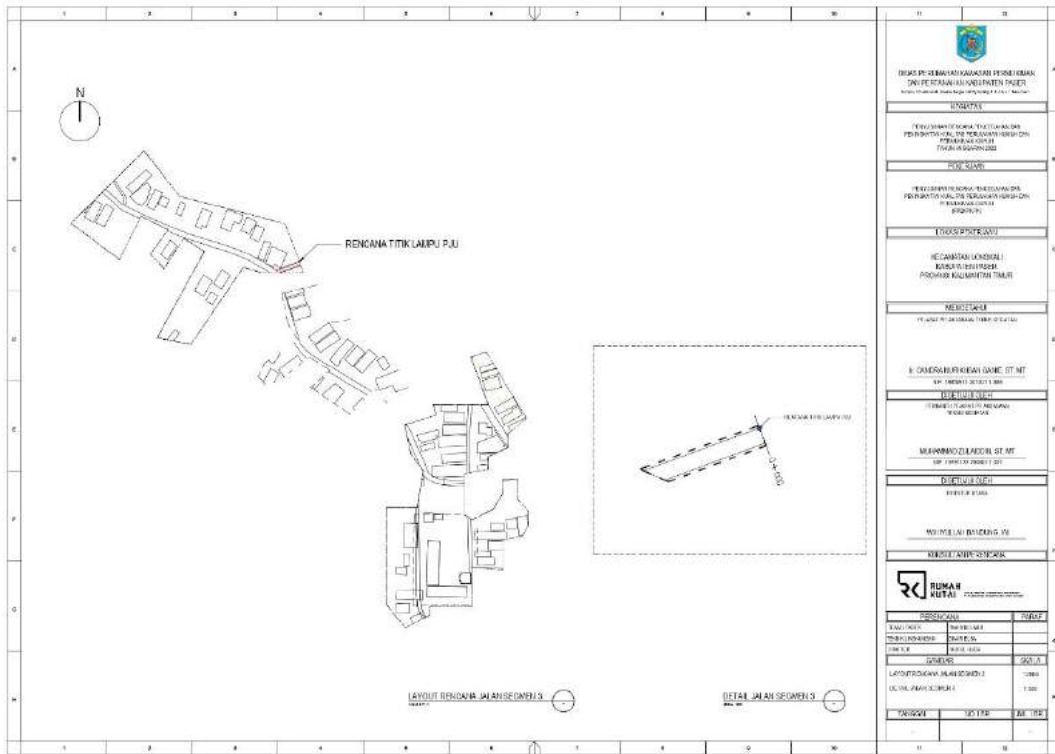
63 Konsep Rencana Titik Lampu RT.11
